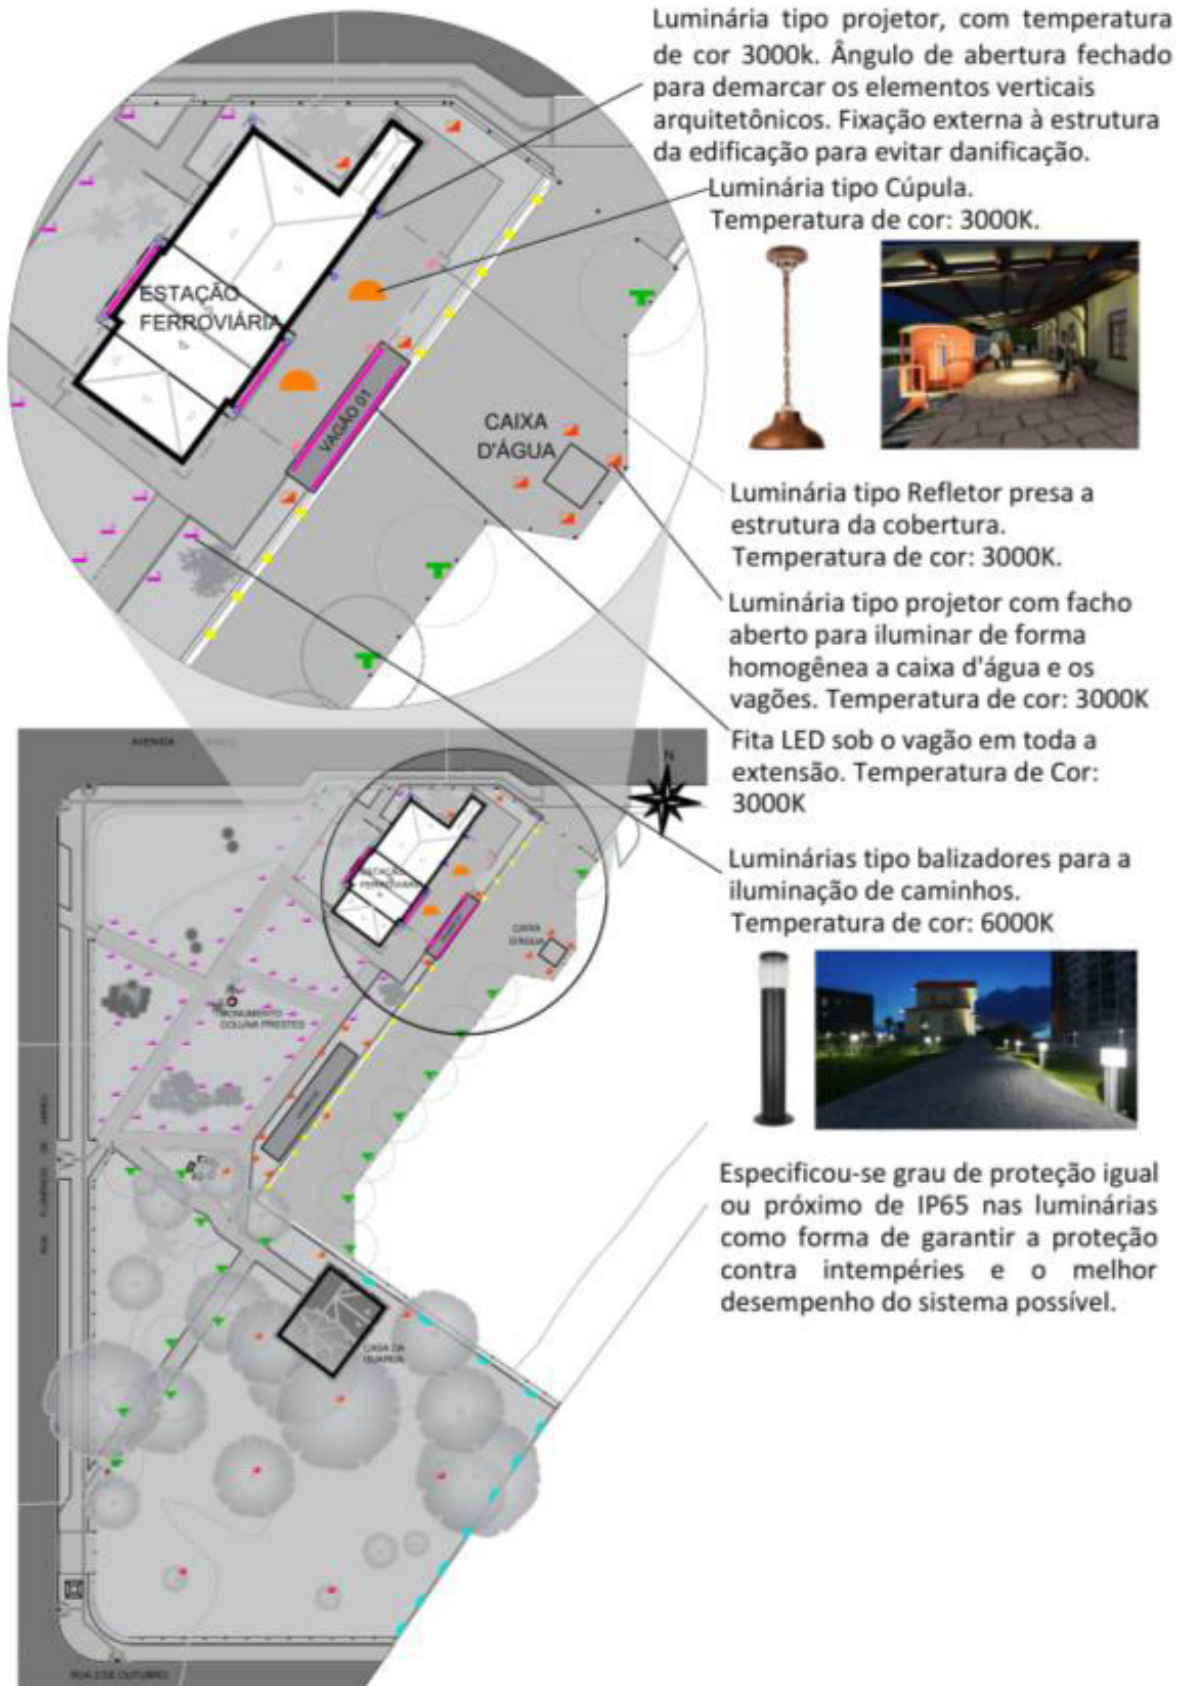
Zoom da planta baixa dos pontos de iluminação com especificações.
